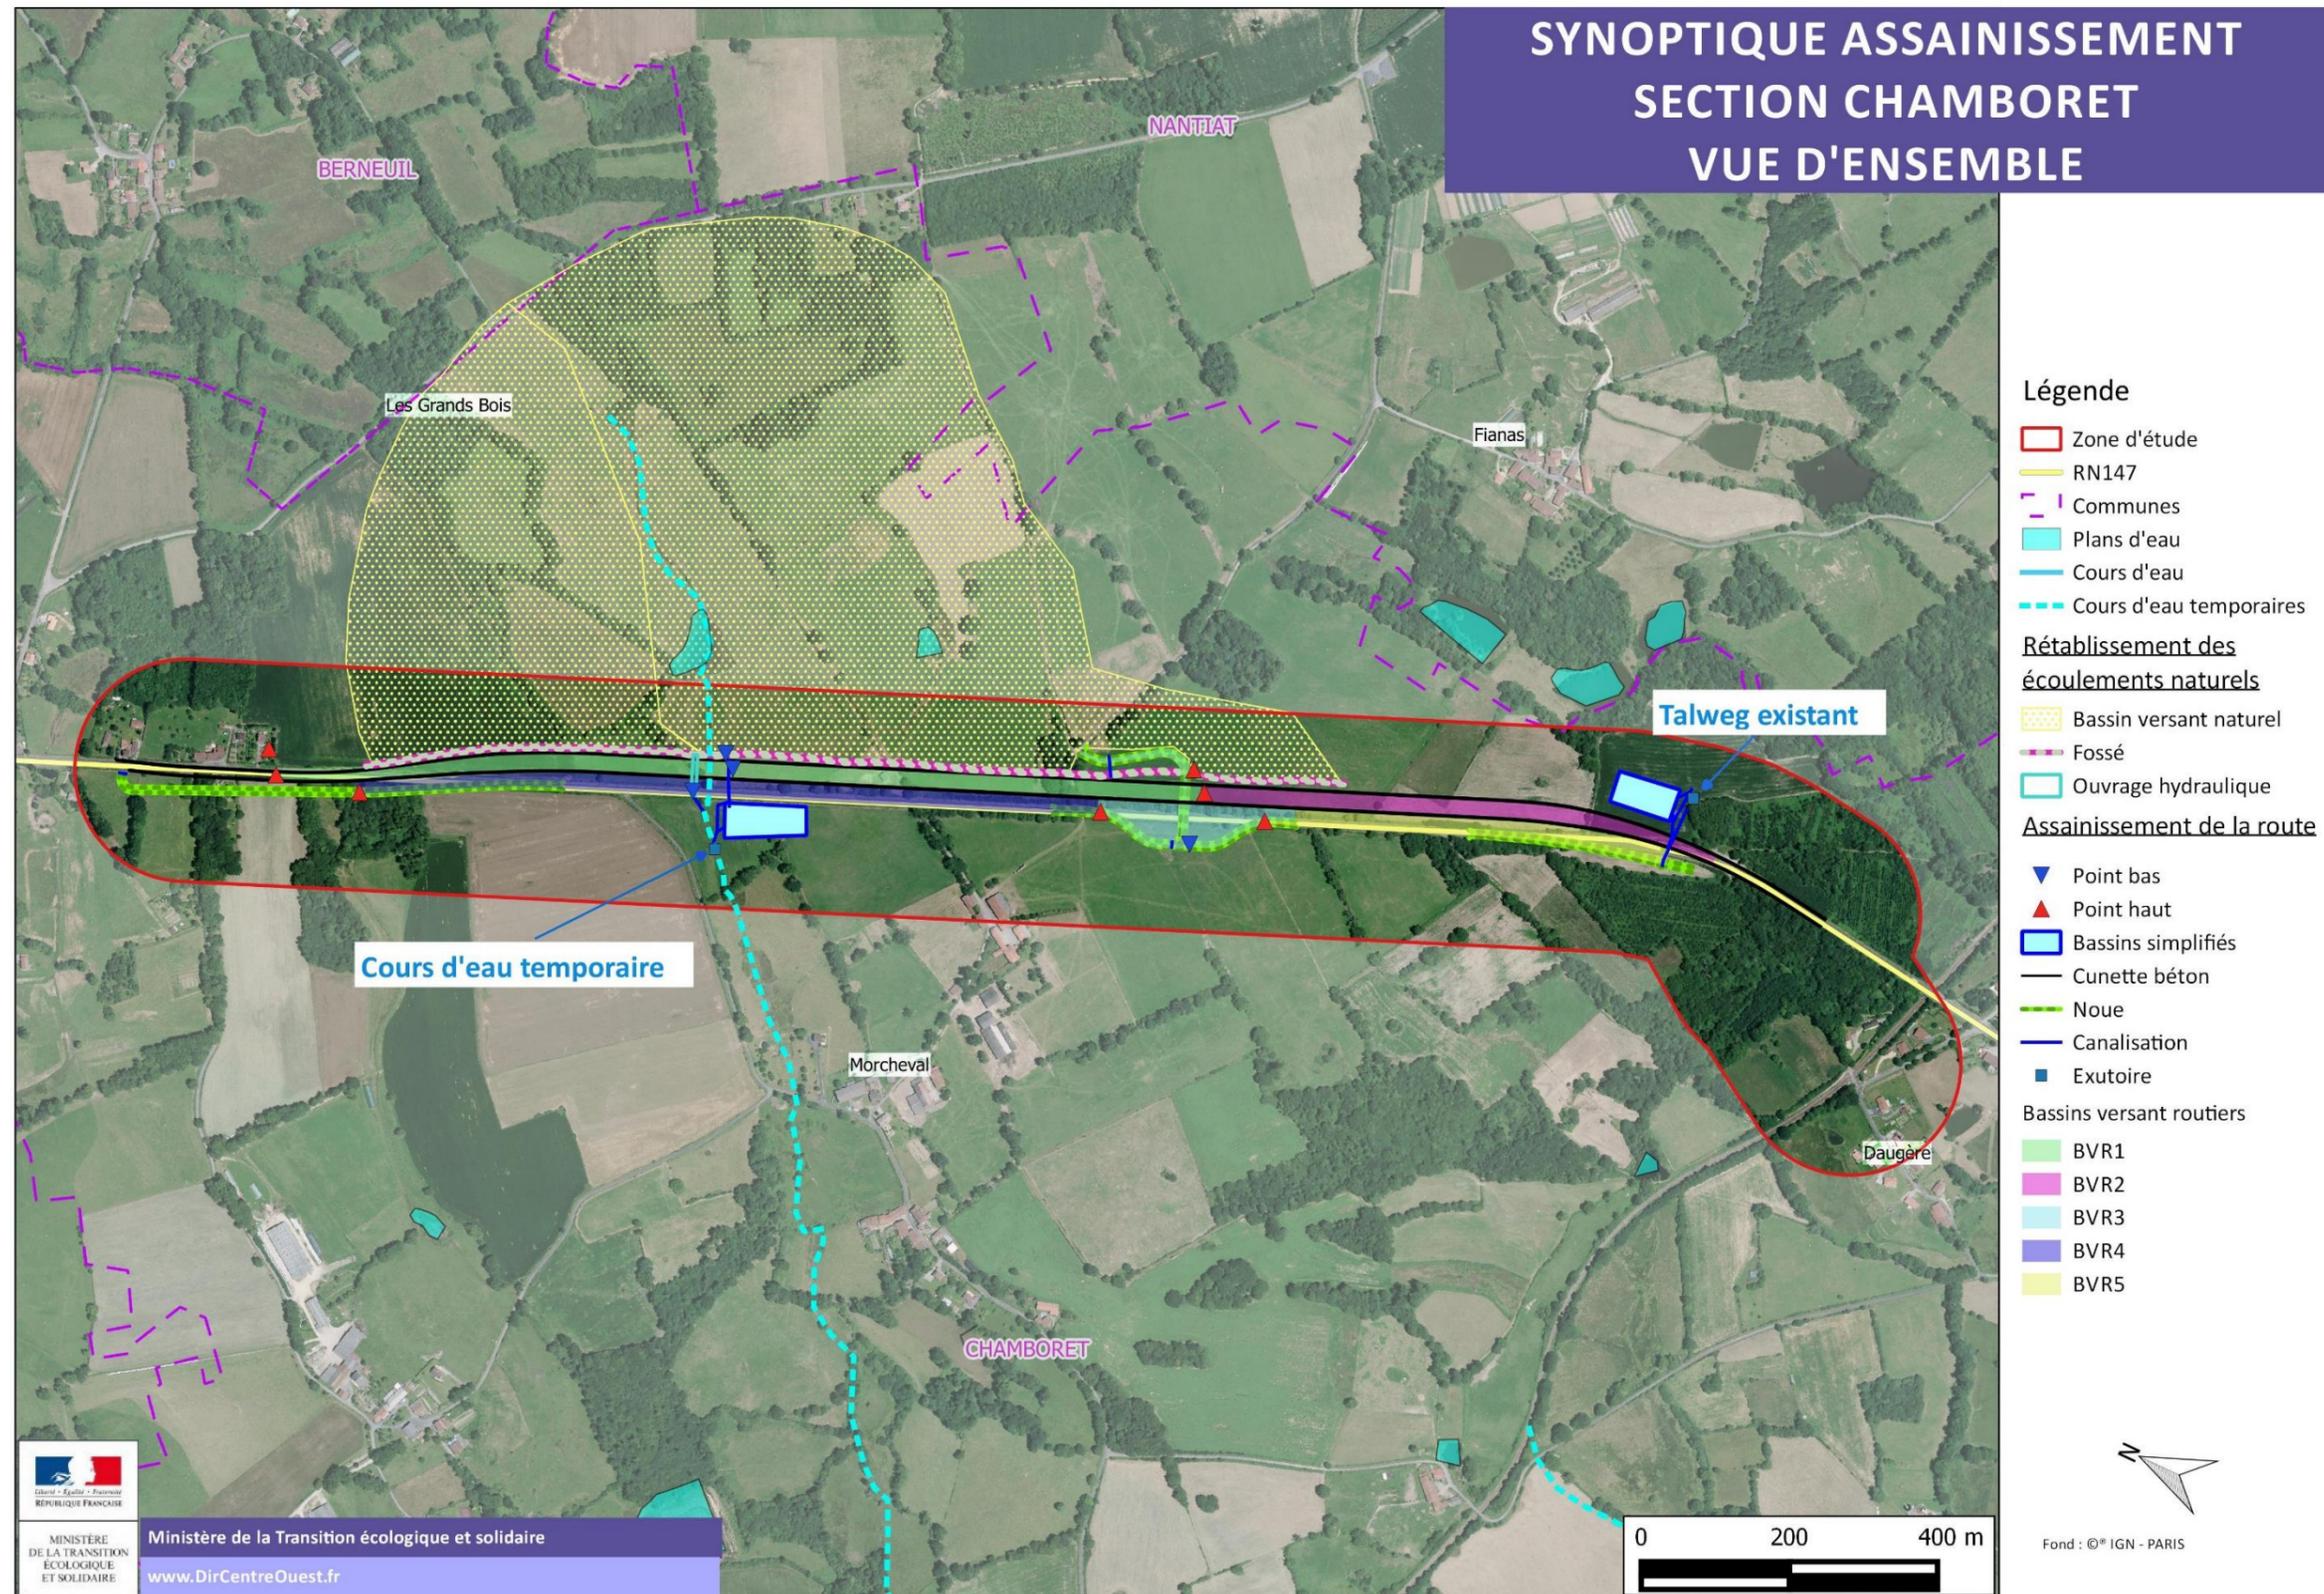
Synoptique assainissement – section Chamboret vue d'ensemble
